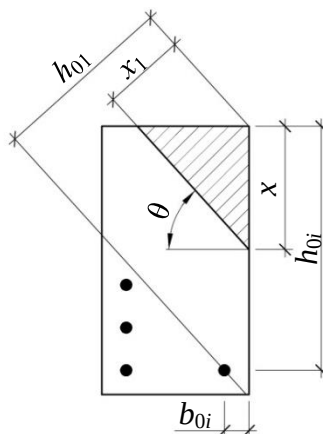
К определению граничной относительной высоты сжатой зоны косоизгибаемого железобетонного элемента [68]
